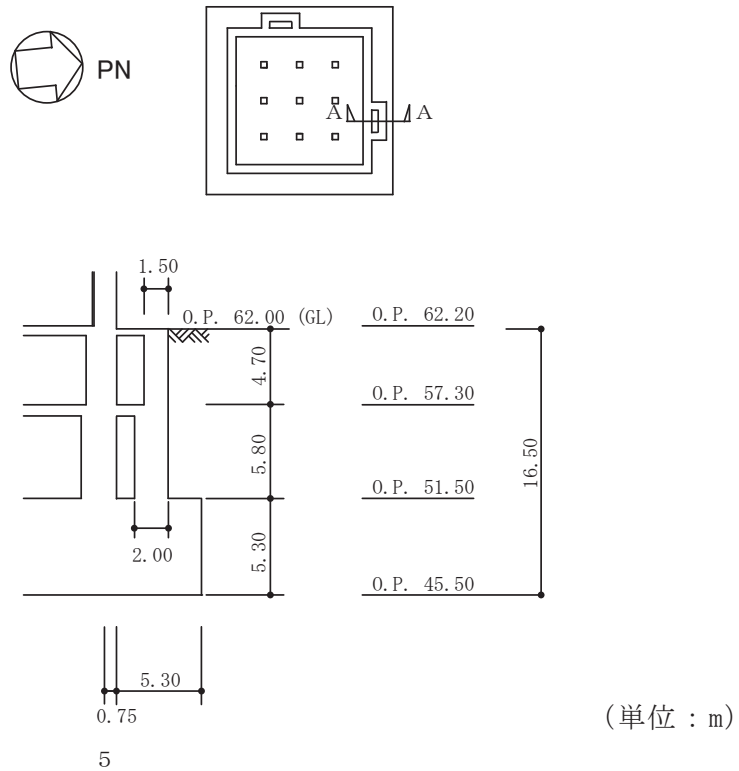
(1) 緊急時対策建屋の概略断面図 (A-A 断面, NS 方向)
